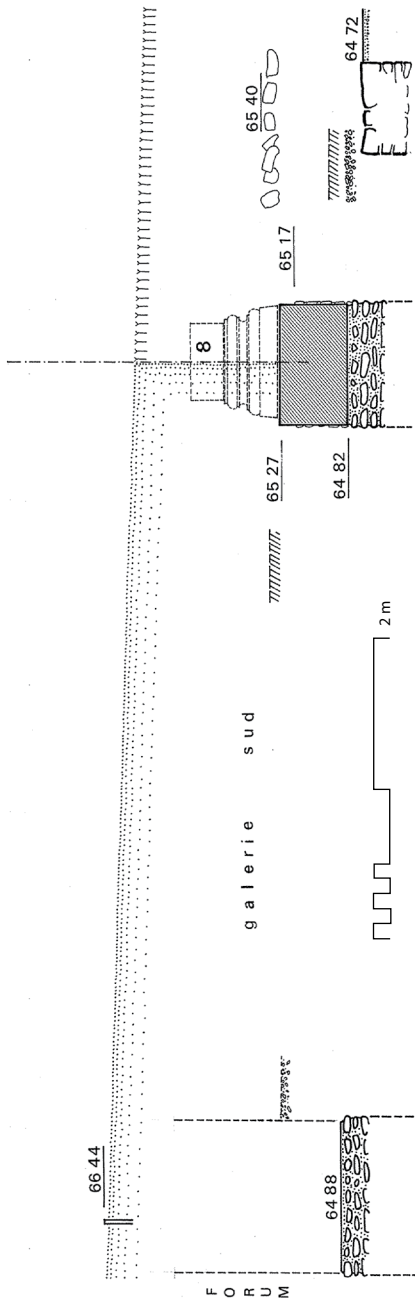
Coupe AA sur le portique sud, au droit de la colonne 8 (G. Hallier).
